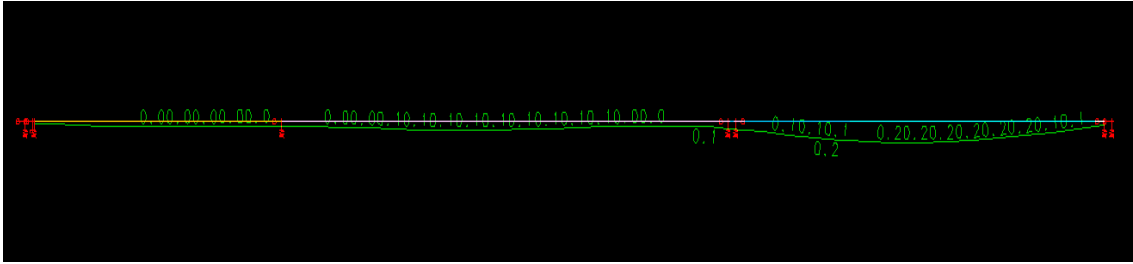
Deslocamentos verticais viga V14 do 1º pavimento, concreto armado (CAD/TQS)
